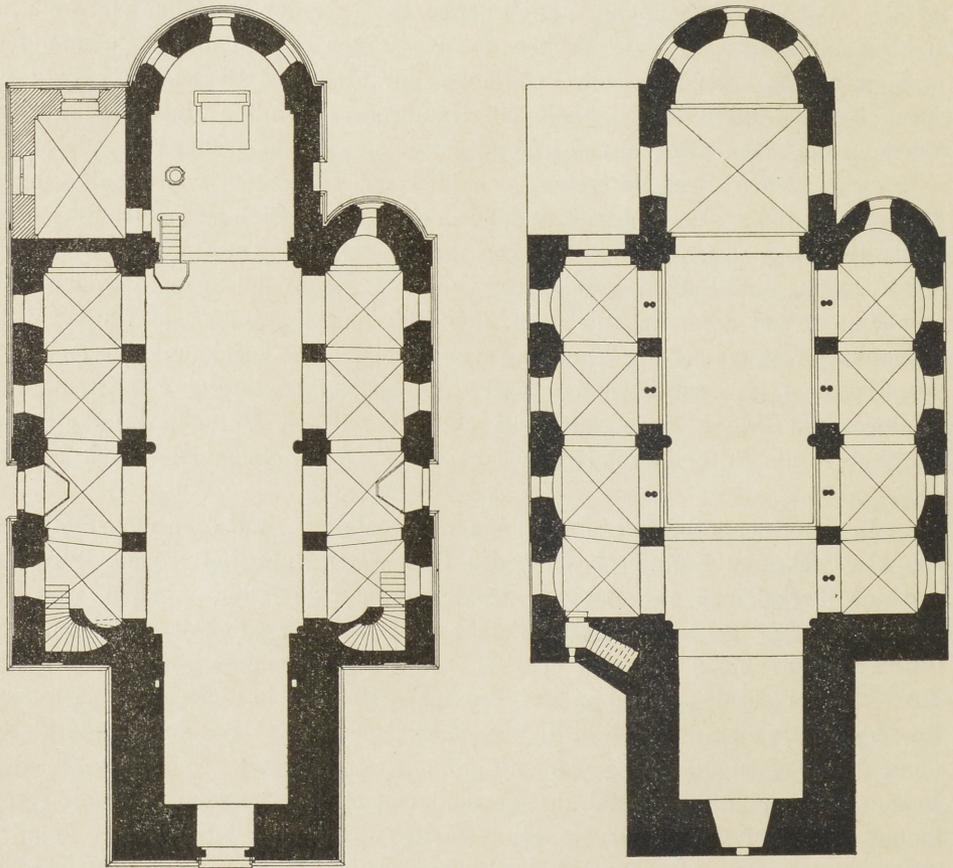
Hilden. Grundrisse der evangel. Pfarrkirche.
